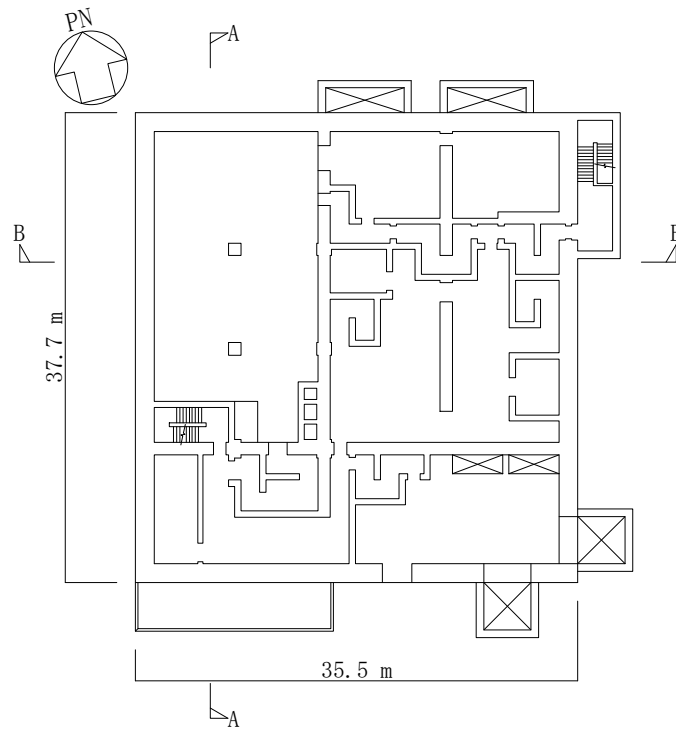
(2/5) 緊急時対策所建屋の概略平面図 (2 階平面図 : EL. 30.3 m)
